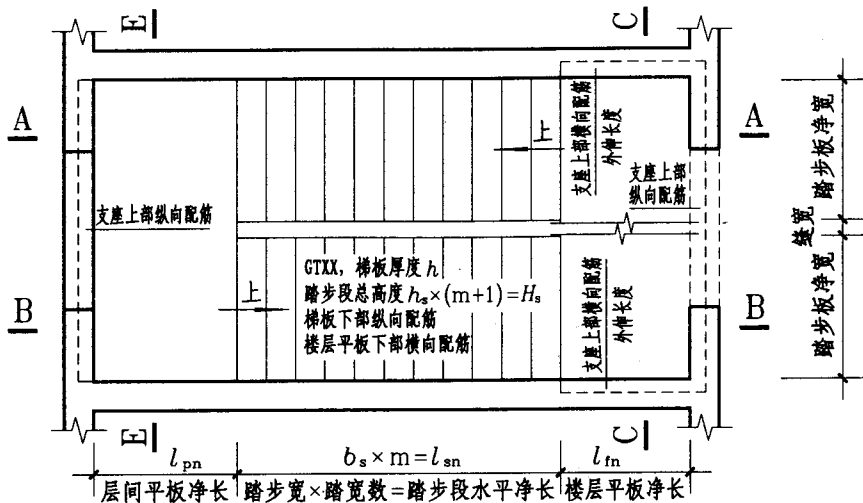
注写方式 标高XXX—标高XXX楼梯平面图
